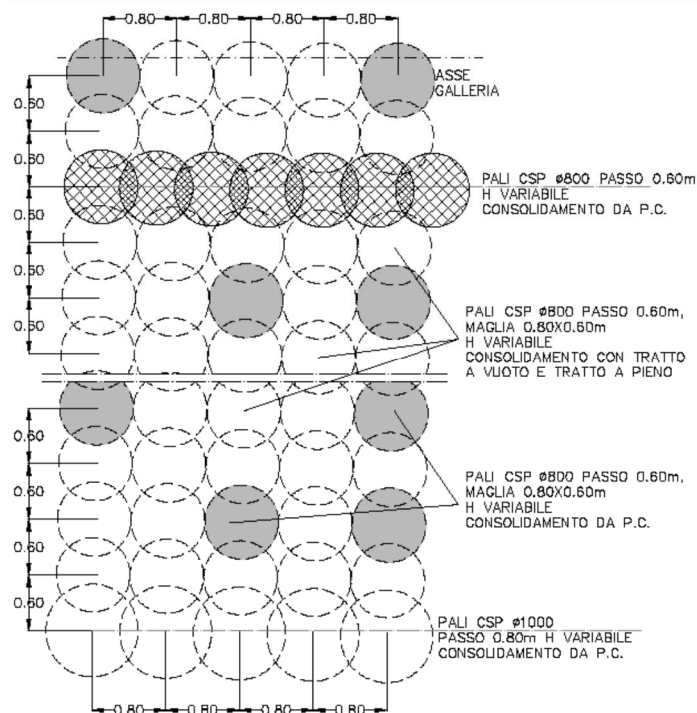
Pianta tipo dei consolidamenti – Sezione tipo C1 dall’alto
